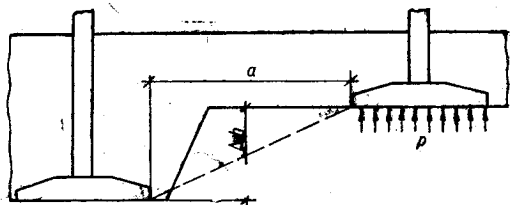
Схема примикання фундаментів, які проектують до існуючих
